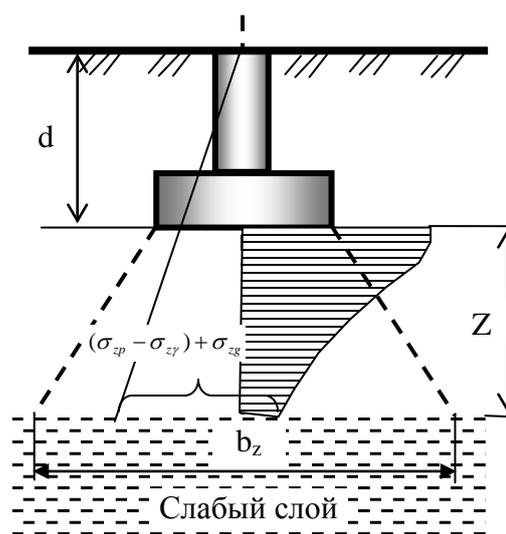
Расчетная схема фундамента к проверке слабого подстилающего слоя
